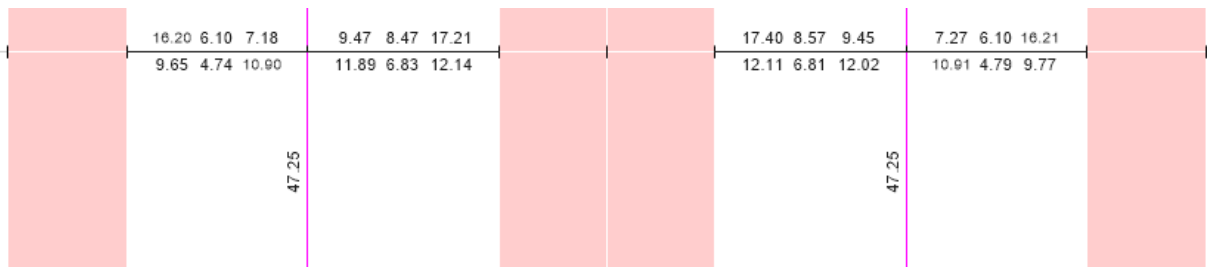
Acero Requerido por momentos en Vigas 6° Piso
